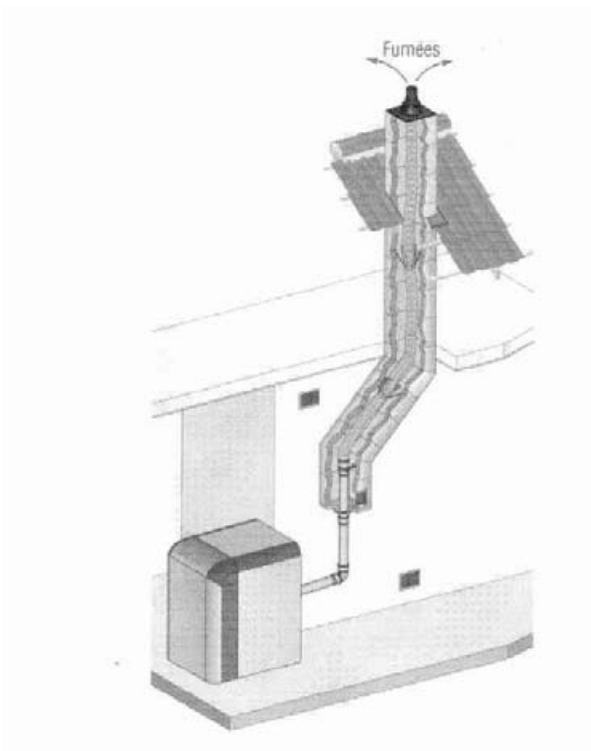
Tubage d'un conduit de fumée fonctionnant en pression positive
